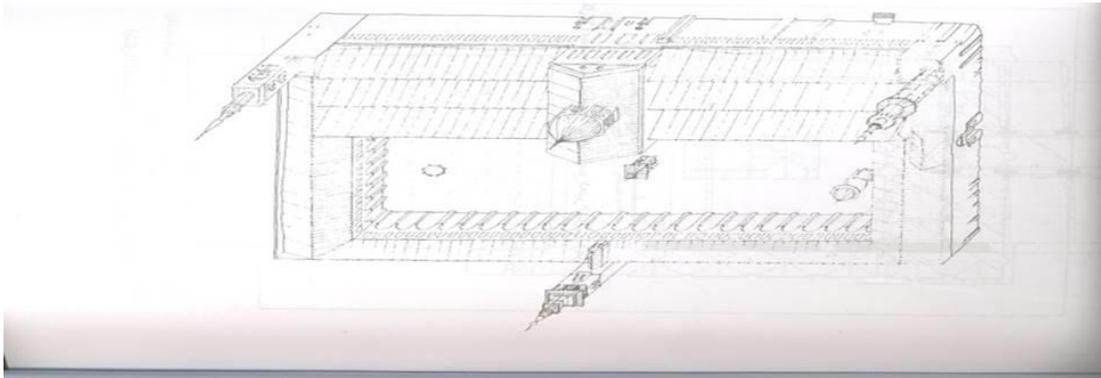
مسقط أفقي لمدرسة صرغتمش بالقاهرة (عن Kessler).
